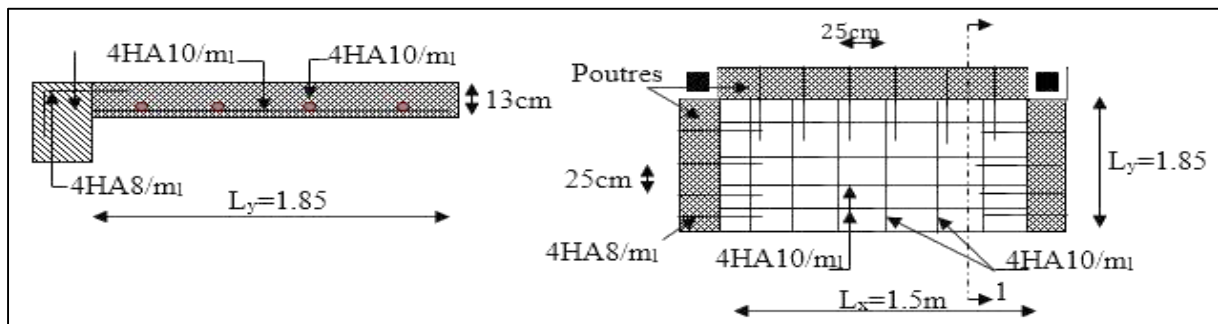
Schéma de ferrailage de la dalle sur 3 appuis.
